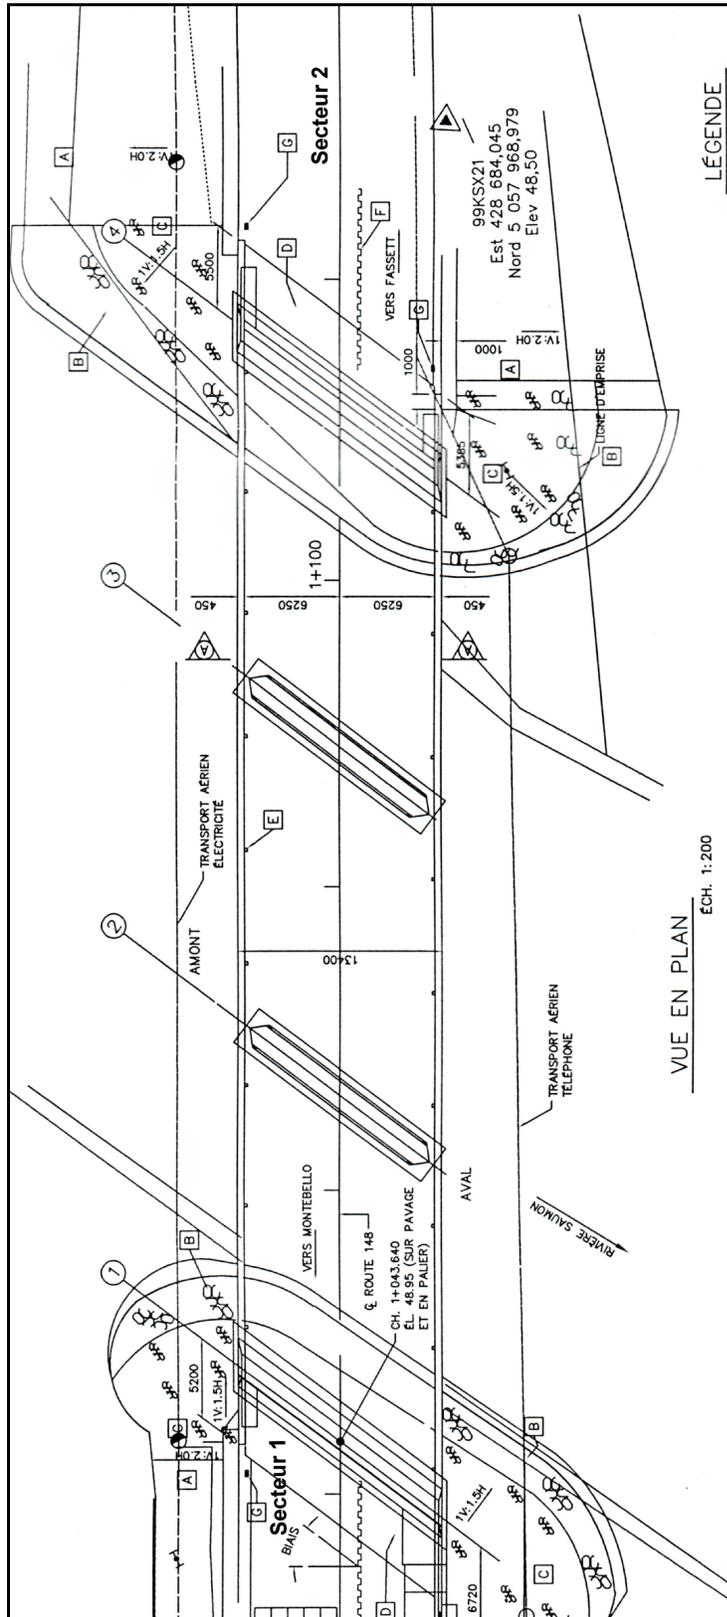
Localisation des secteurs d'inventaire sur le plan de construction du projet 20-6671-9611
